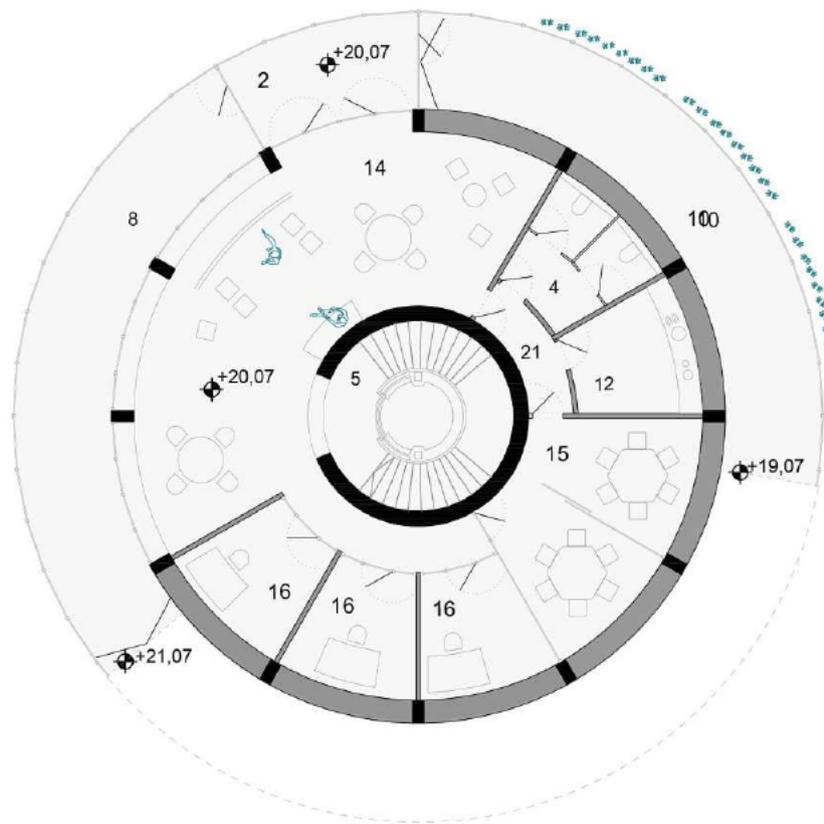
2.4 Grundriss 3.Obergeschoss
